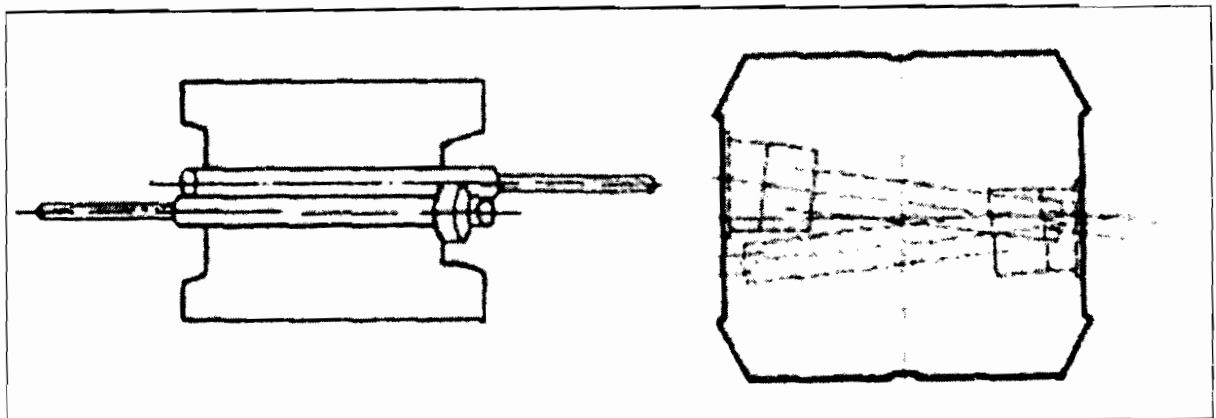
Vue en plan de la disposition des ancrages au niveau du mât
